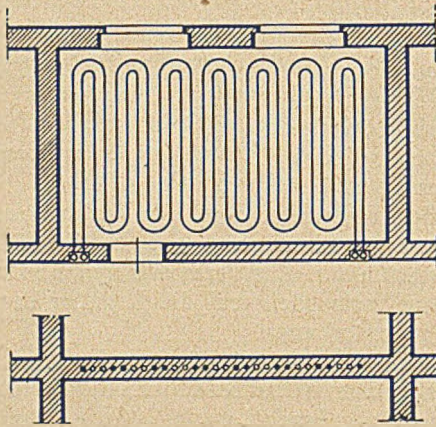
Heizdecke einer Warmwasser-Strahlungsheizung nach dem DRP. 721 059 mit mehrgängigen Heizrohrschlangen.
